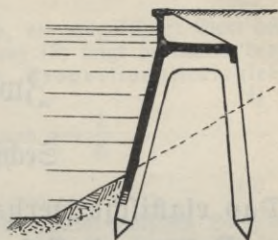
Raimauer zwischen eingerammten Eisenbetonpfählen.
